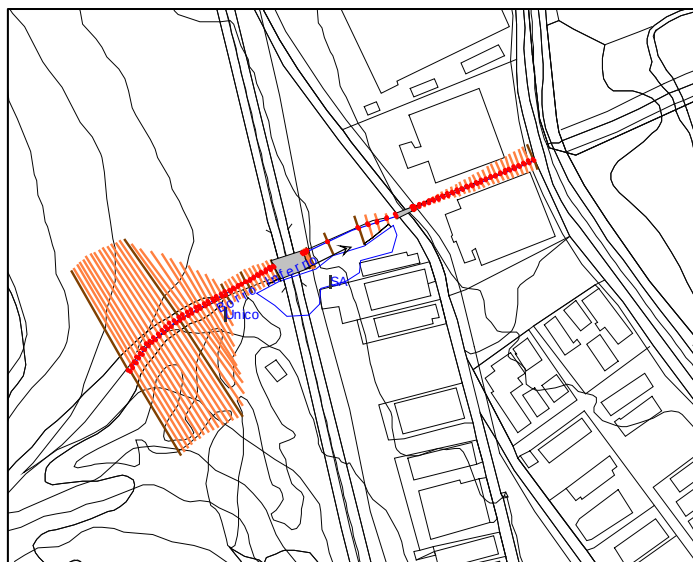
planimetria del Modello Hec-Ras Borro Inferno
